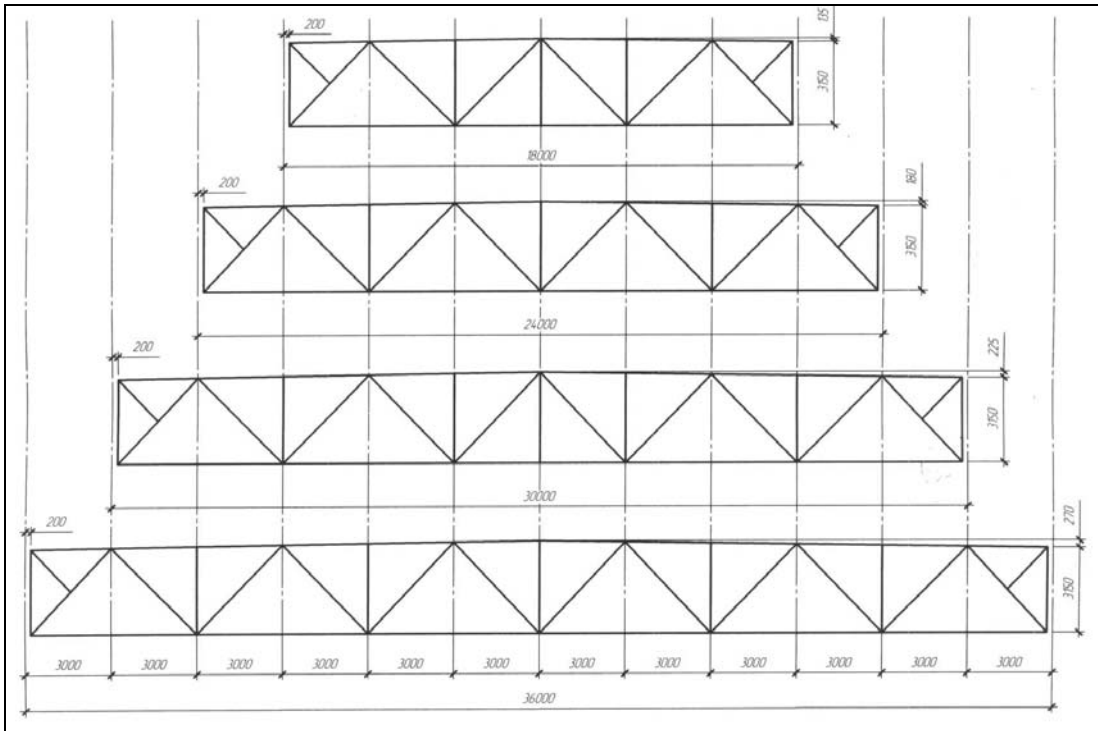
Схемы стропильных ферм (высота 3150 мм измеряется по обушкам поясных уголков)
